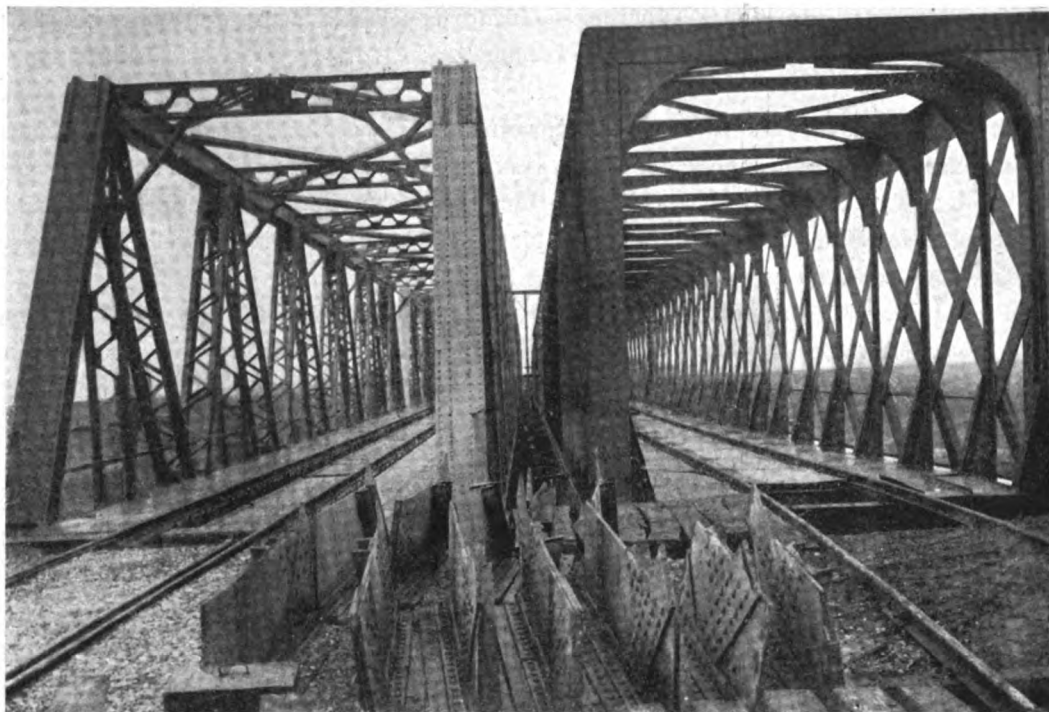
Travate vecchie e nuove del ponte sul Reno presso Lavezzola.
